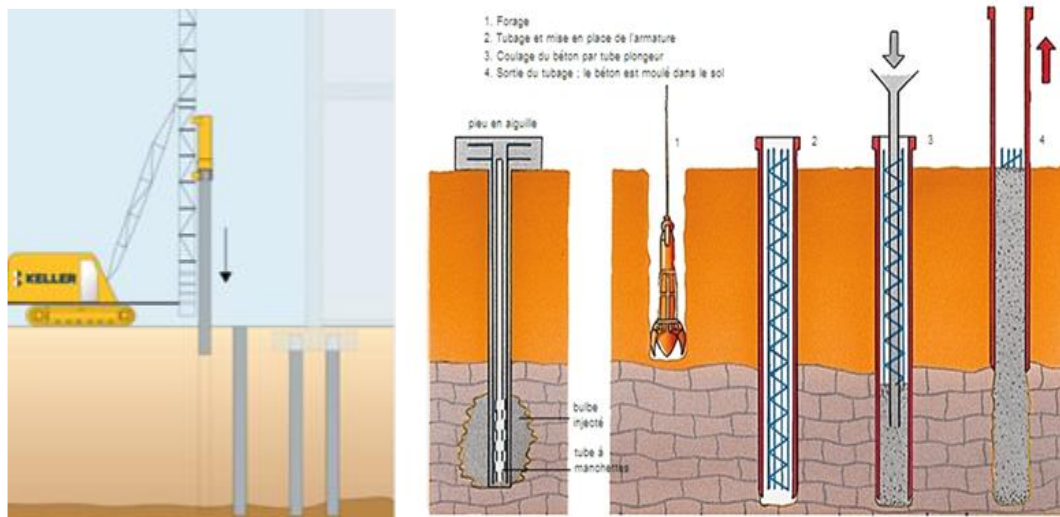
Pieux Préfabriqués Battus et Pieux coulés sur place.
